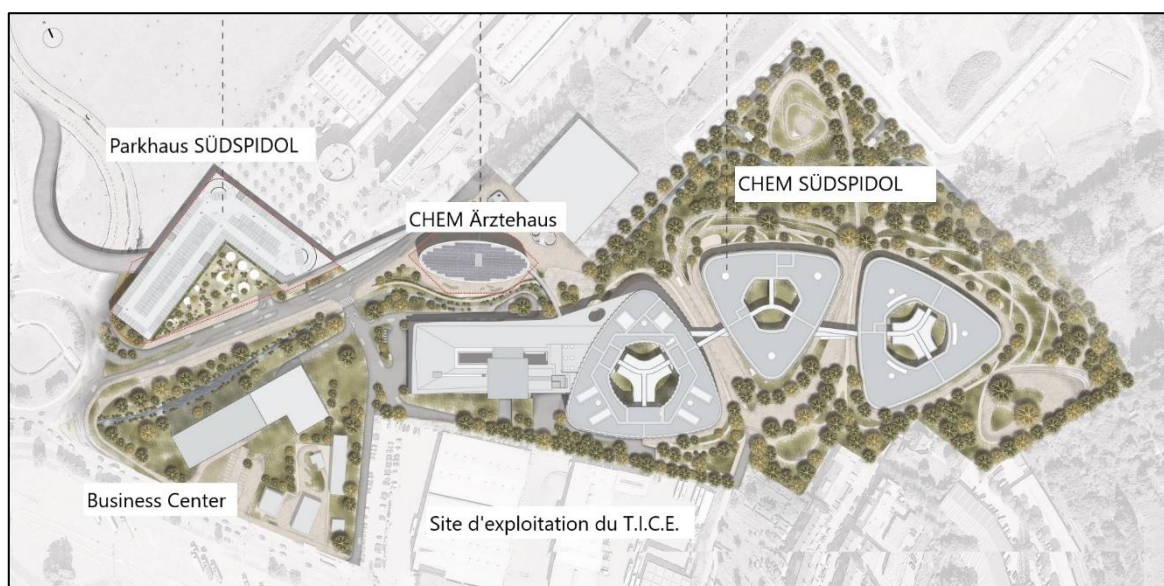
Plan reprenant l'emplacement des projets de construction à proximité du projet de forages
